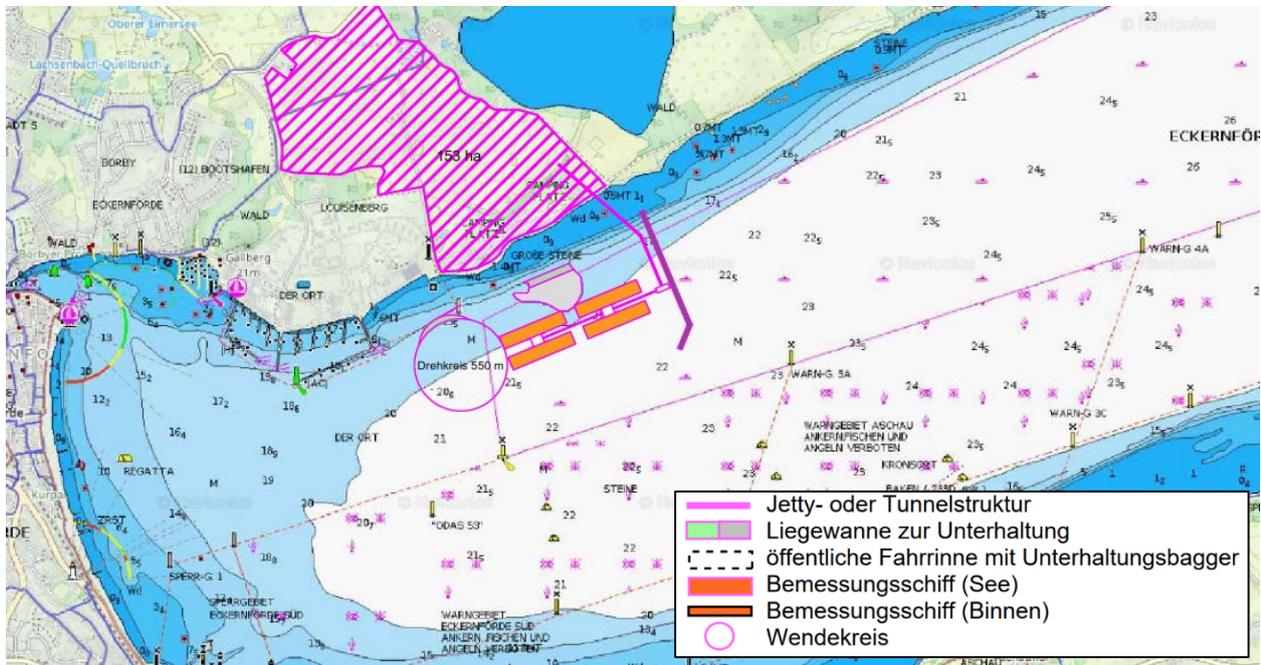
Lageplan Alternative 10: Eckernförde¹⁹¹
